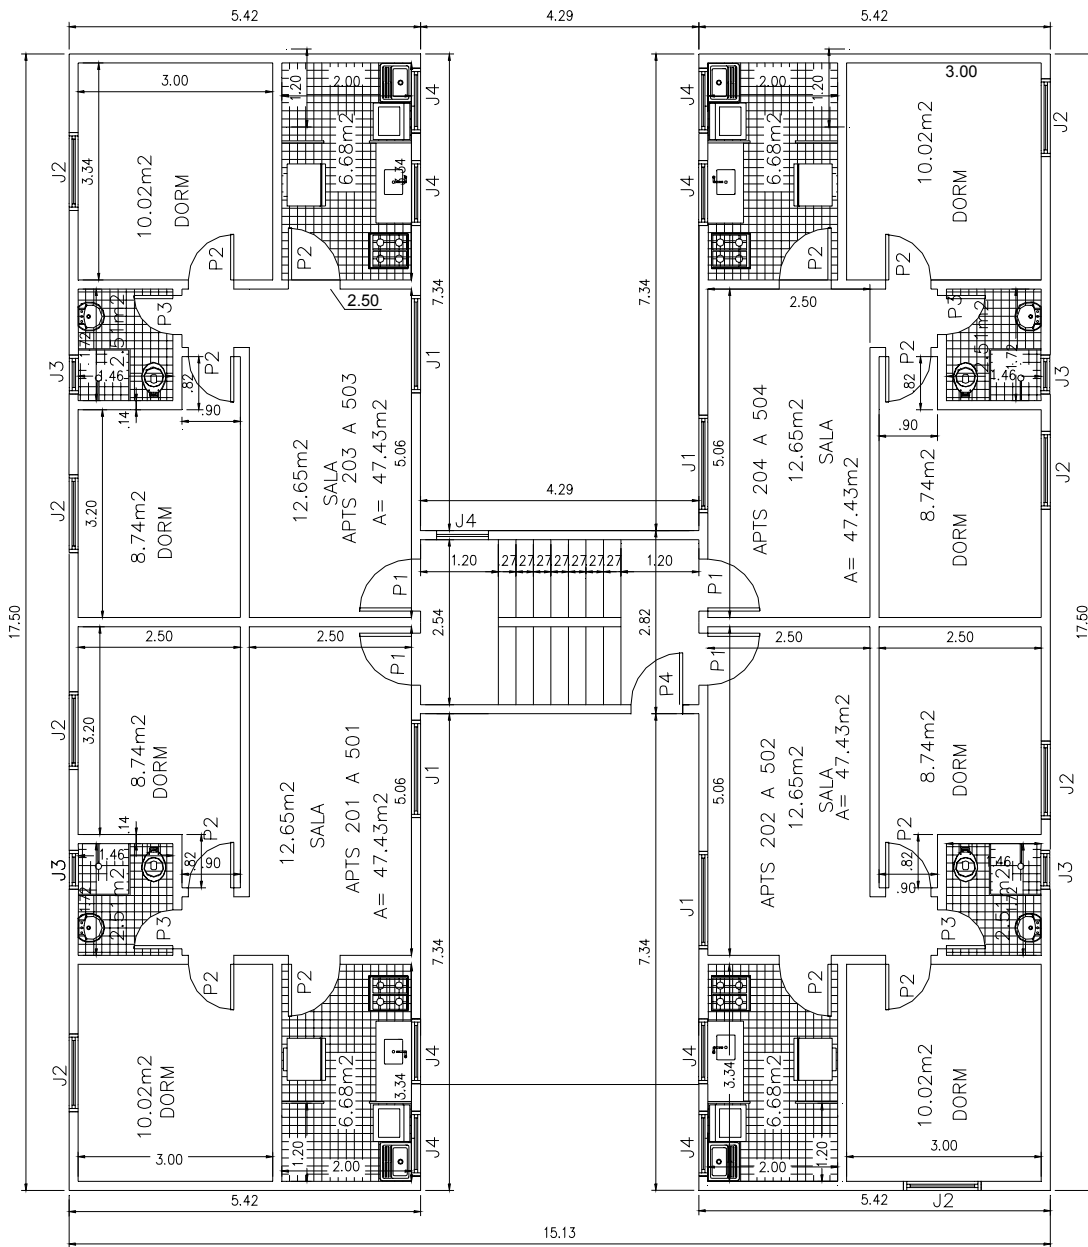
Residencial “J” – Bloco 4 – Pavimento tipo
